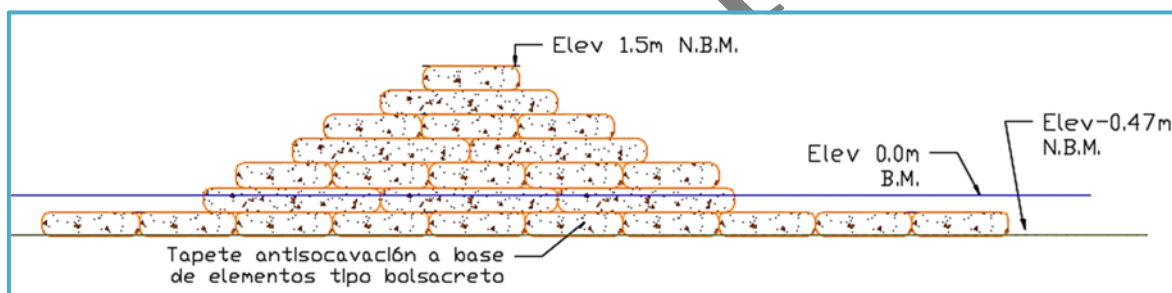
Sección transversal tipo de la estructura de protección tipo espigón.
